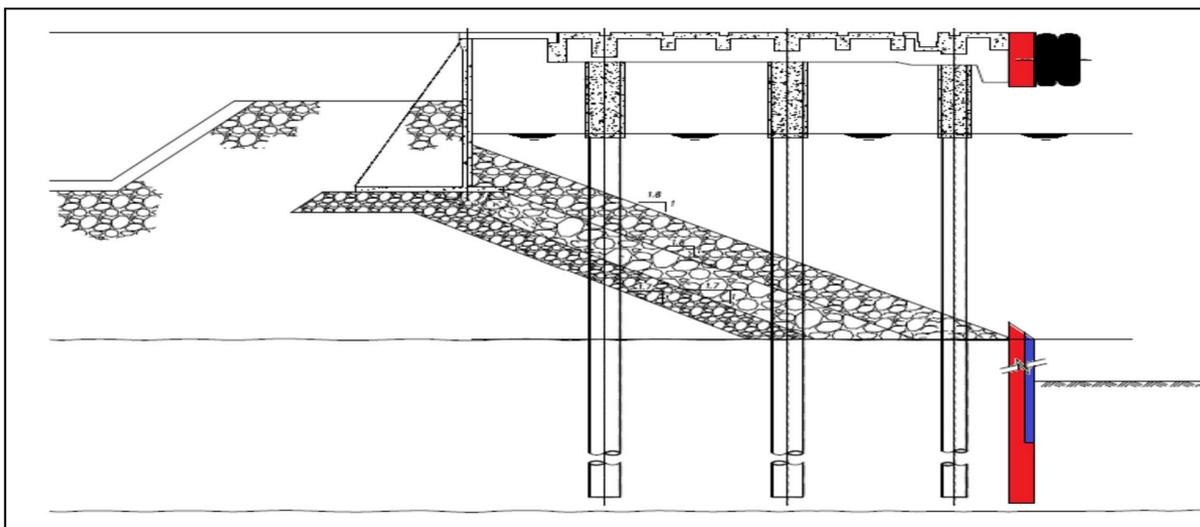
Esquema Estructura Adicional Sitio 5 sección transversal
